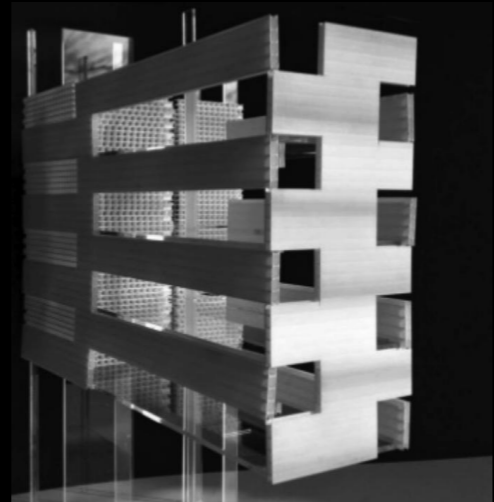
Fuente: Skylar Morán SECCIÓN DE MAQUETA SISTEMA ESTRUCTURAL
